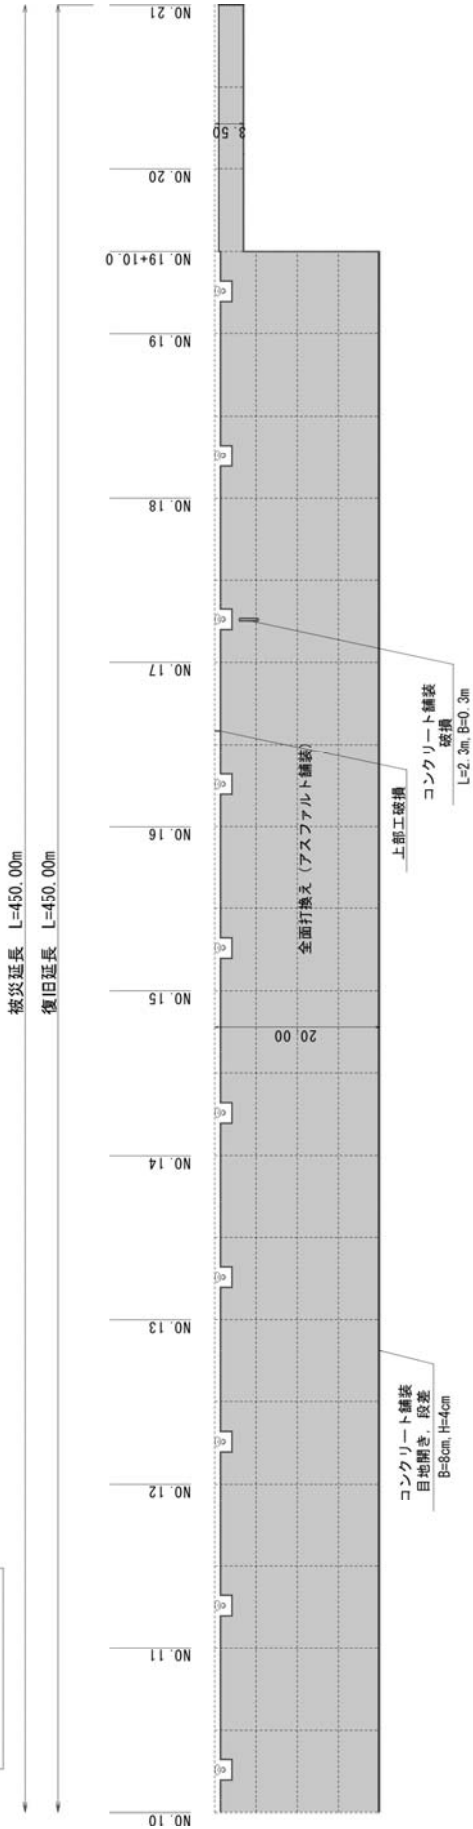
(a) 香椎パークポート地区-7.5m岸壁の復旧後平面図
